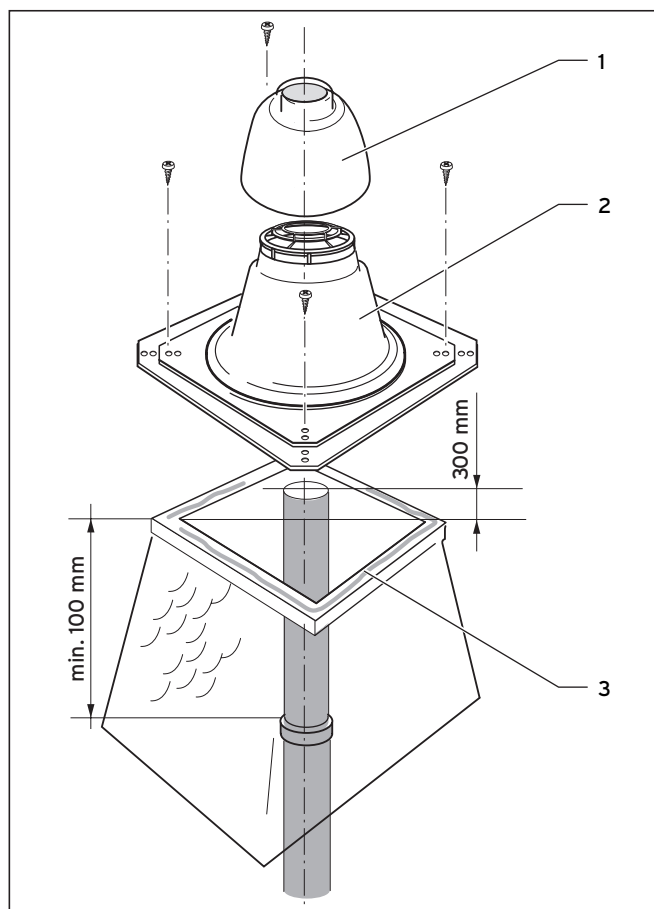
Montage du chapeau de cheminée réf. 303 963
